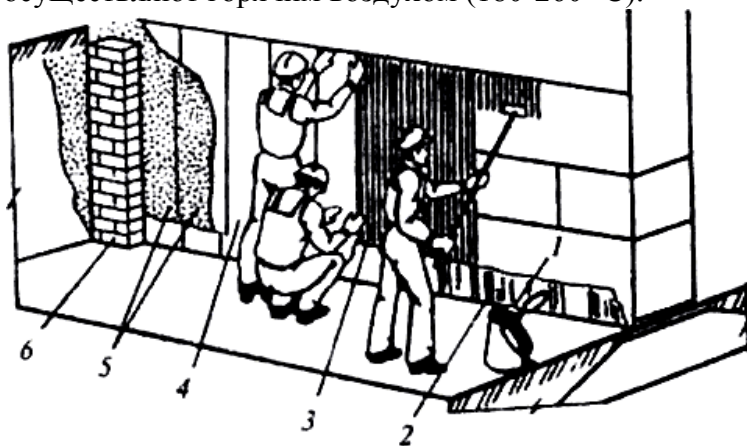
Устройство вертикальной оклеенной гидроизоляции:
